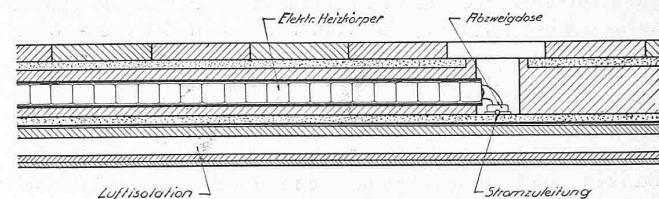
und 3. Querschnitt und Längsschnitt durch einen Fußboden auf Holzbalkenkonstruktion mit eingebauter elektrischer Heizung System „Electra“.
